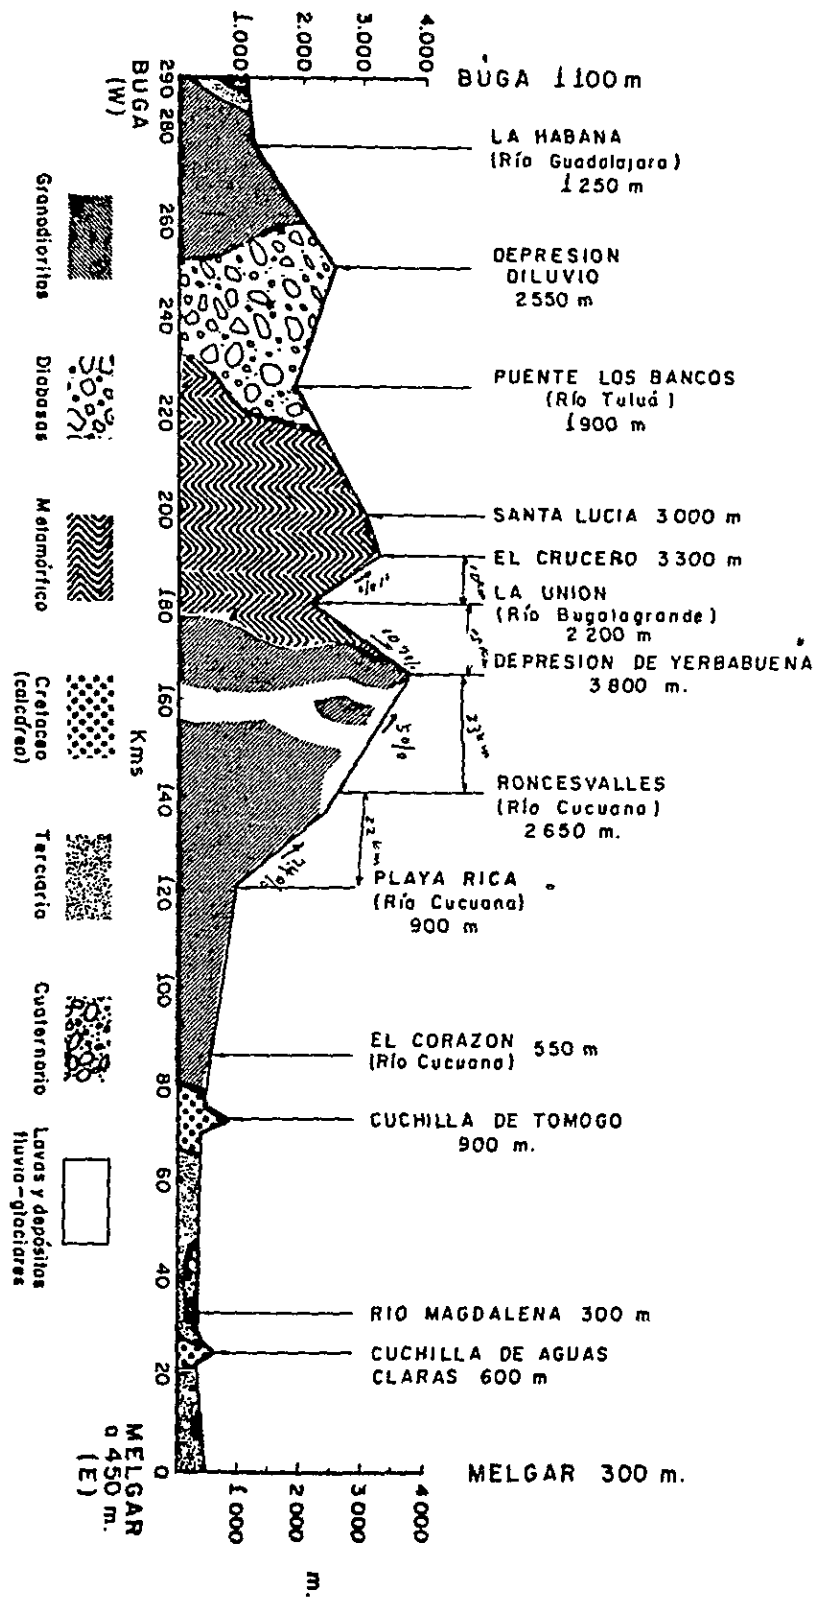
PERFIL LONGITUDINAL DEL PROYECTO MELGAR-BUGA - ALTERNATIVA 1
